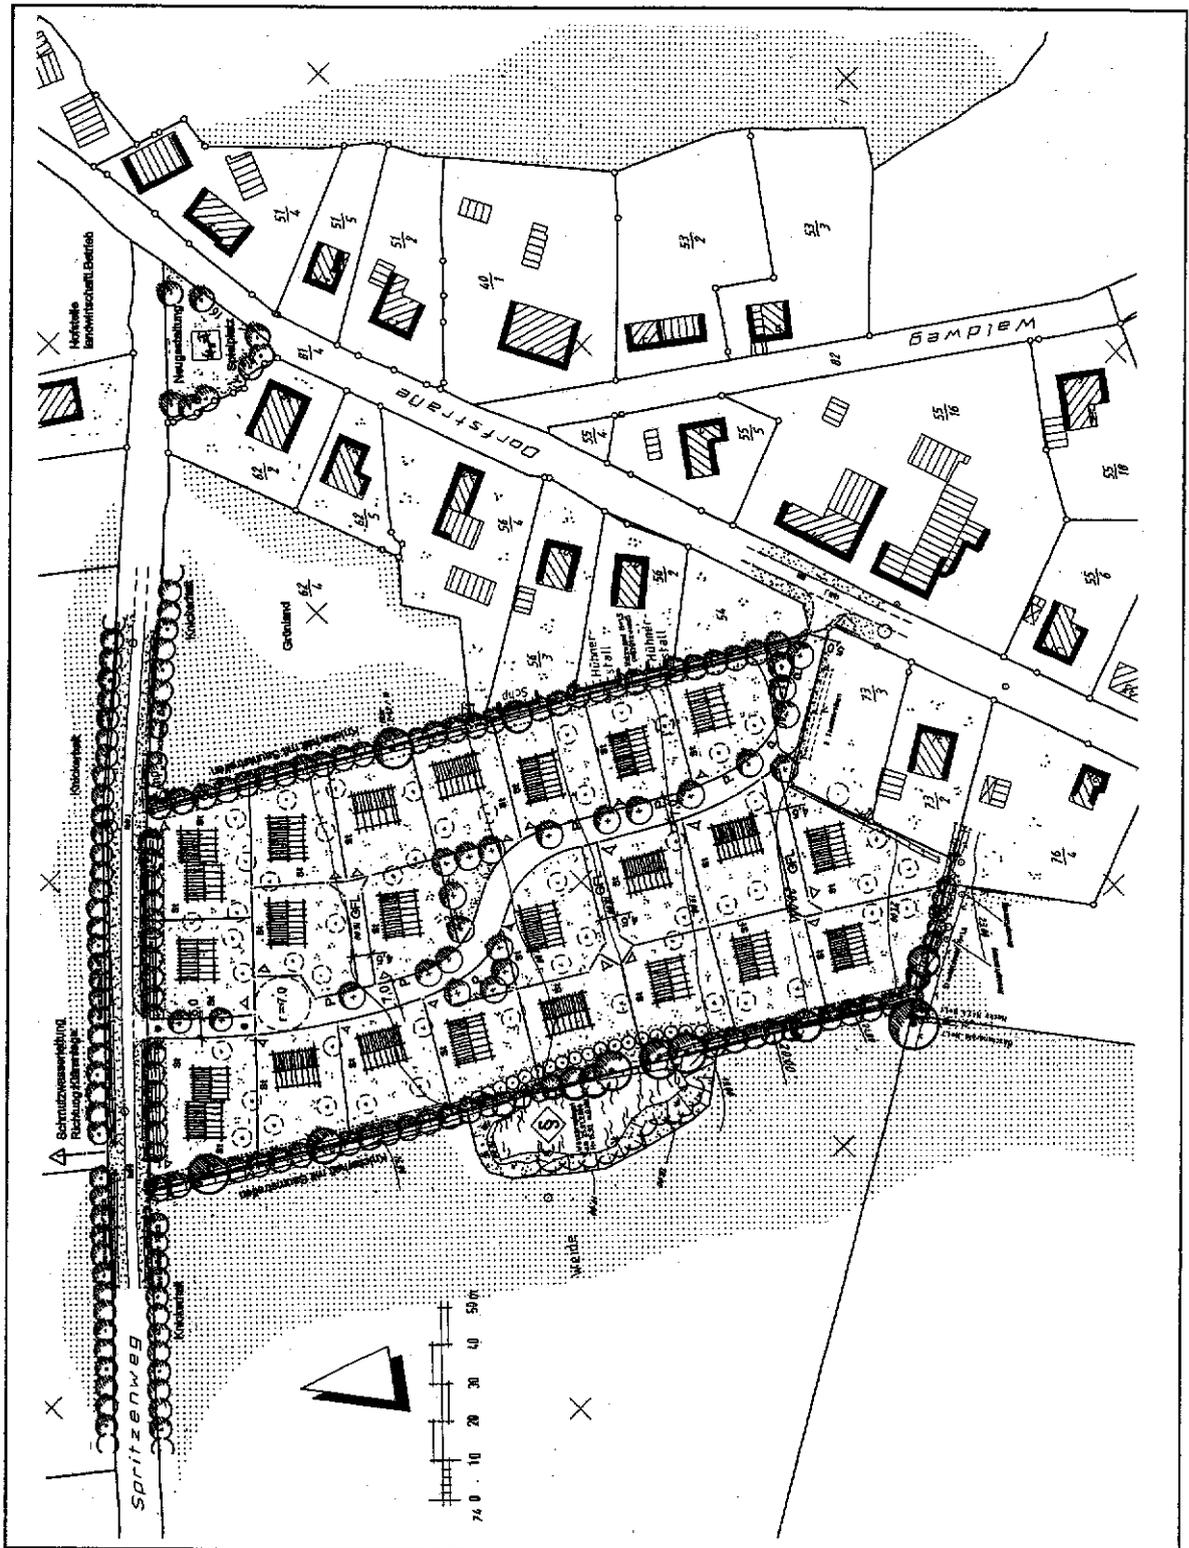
Planausschnitt aus „Städtebauliches Konzept mit integrierter Landschaftsplanung“ Entwurf vom 07.02.2000 zum Bauungsplan Nr. 3 „Spritzenweg“, unmaßstäblich
